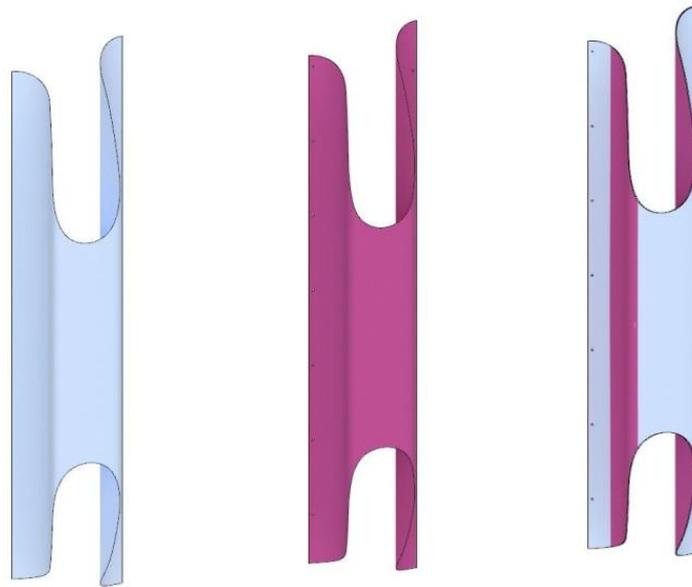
Modelle der Fassade für das RKM Tower [33]
